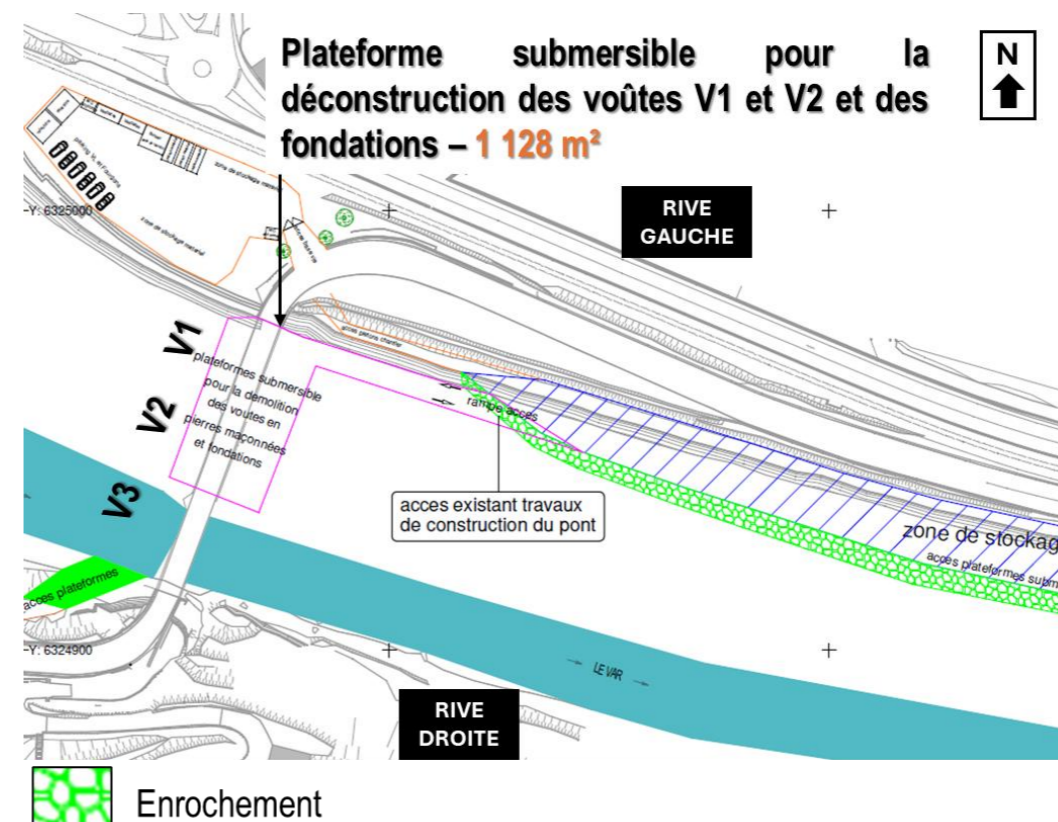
Installations de chantier pour la déconstruction du pont existant
